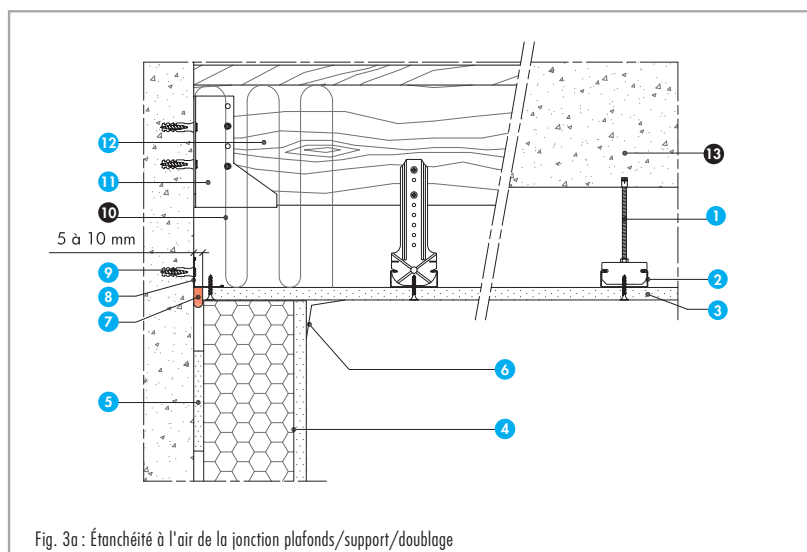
Étanchéité à l'air de la jonction plafonds/support/doublage
